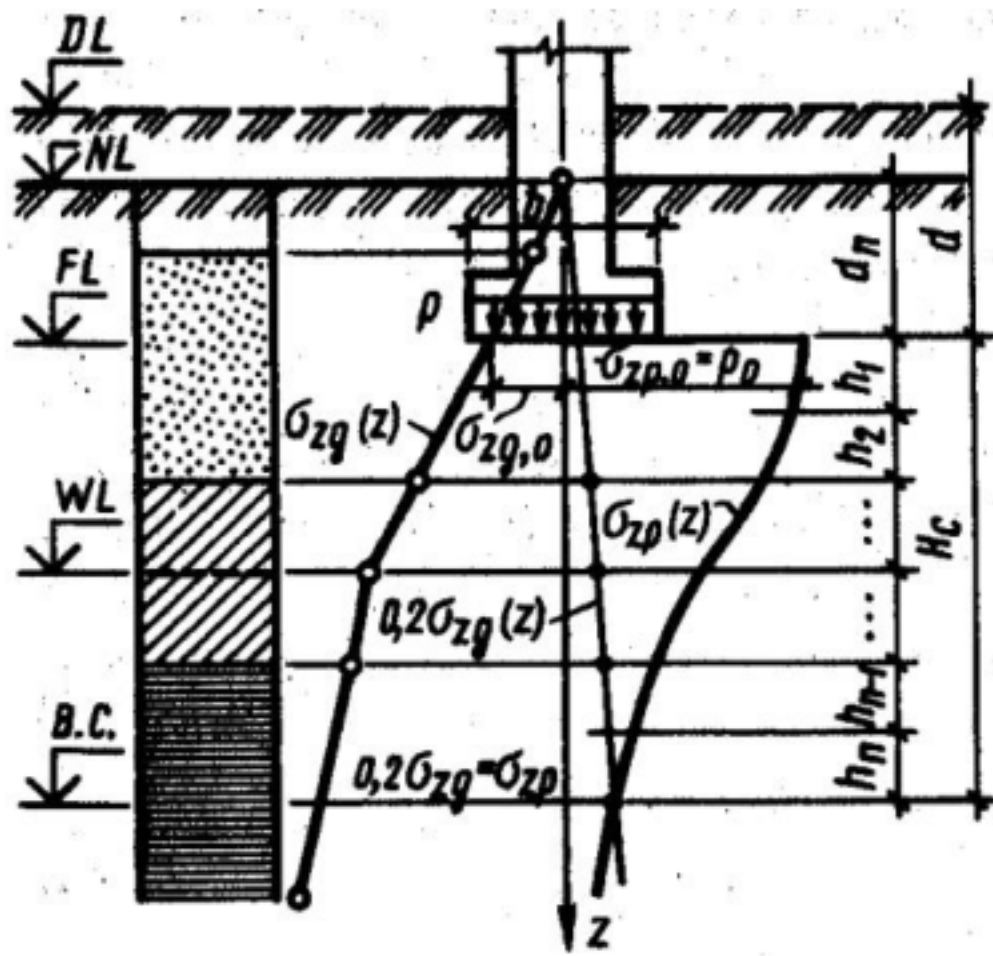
Литологическая колонка и расчётная схема для определения осадок методом послойного суммирования: DL – отметка планировки; NL – отметка поверхности природного рельефа; FL – отметка подошвы фундамента; WL – уровень подземных вод; В.С. – нижняя граница сжимаемой толщи.
